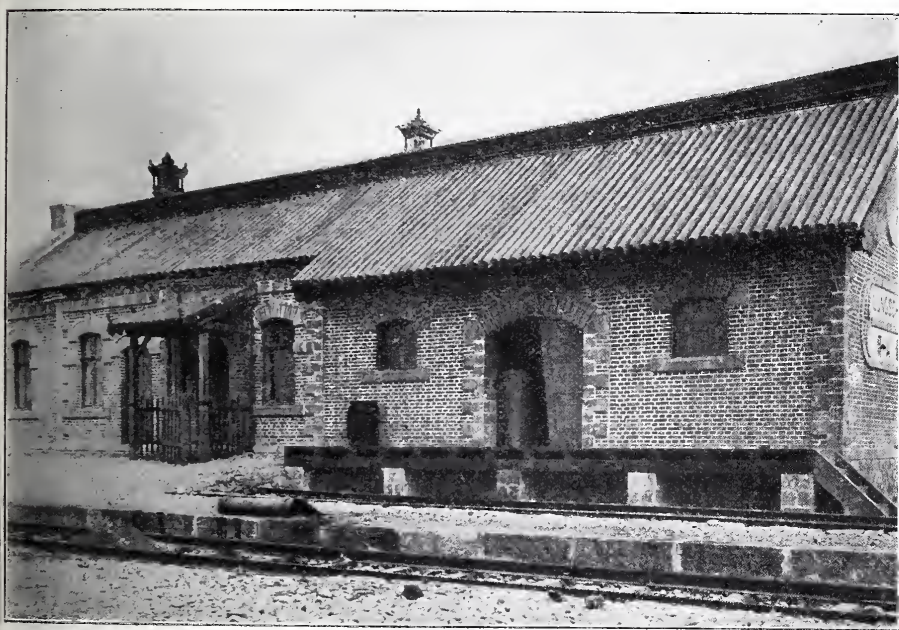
Haltestellen-Empfangsgebäude mit angebautem Güterschuppen.
